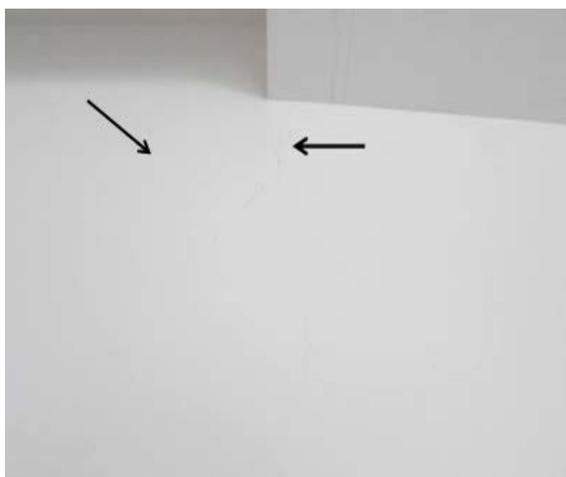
2ª vistoria. Imagem detalhada da Fissura vide figura 18.
